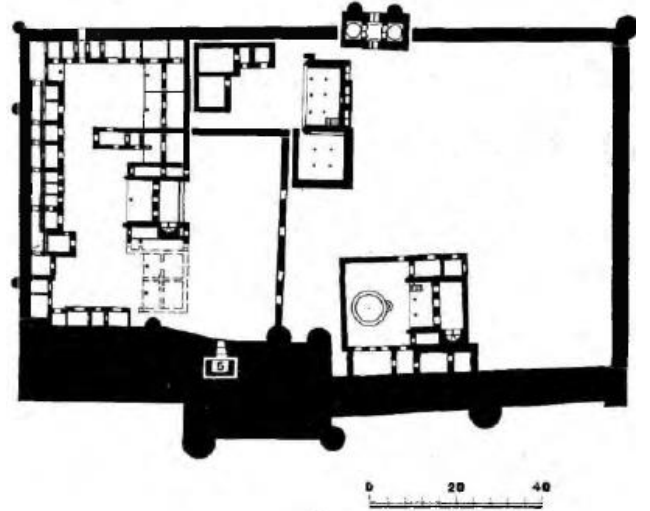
Köhne Ark Sarayı Giriş Kapısı Doğu Cephe Plan-1. (1977)
